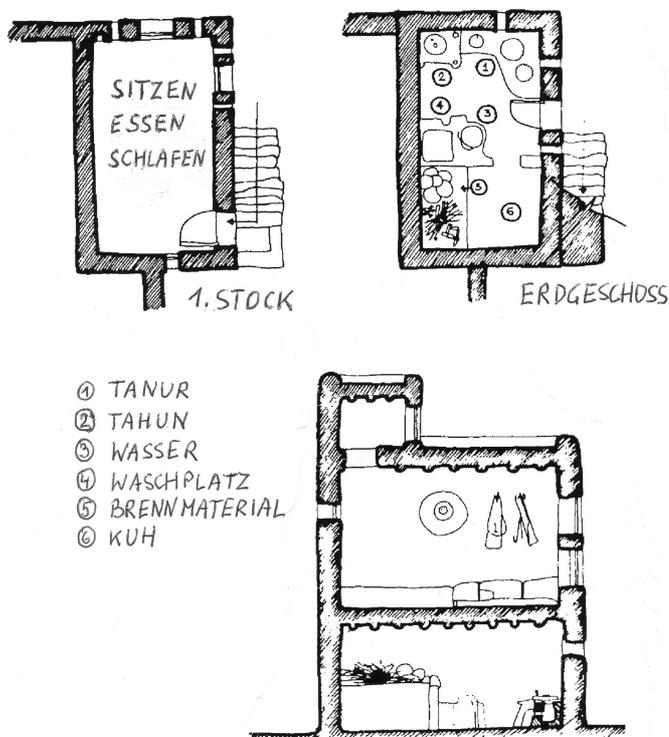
Grundrisse und Längsschnitt eines einstöckigen Lehmhauses
